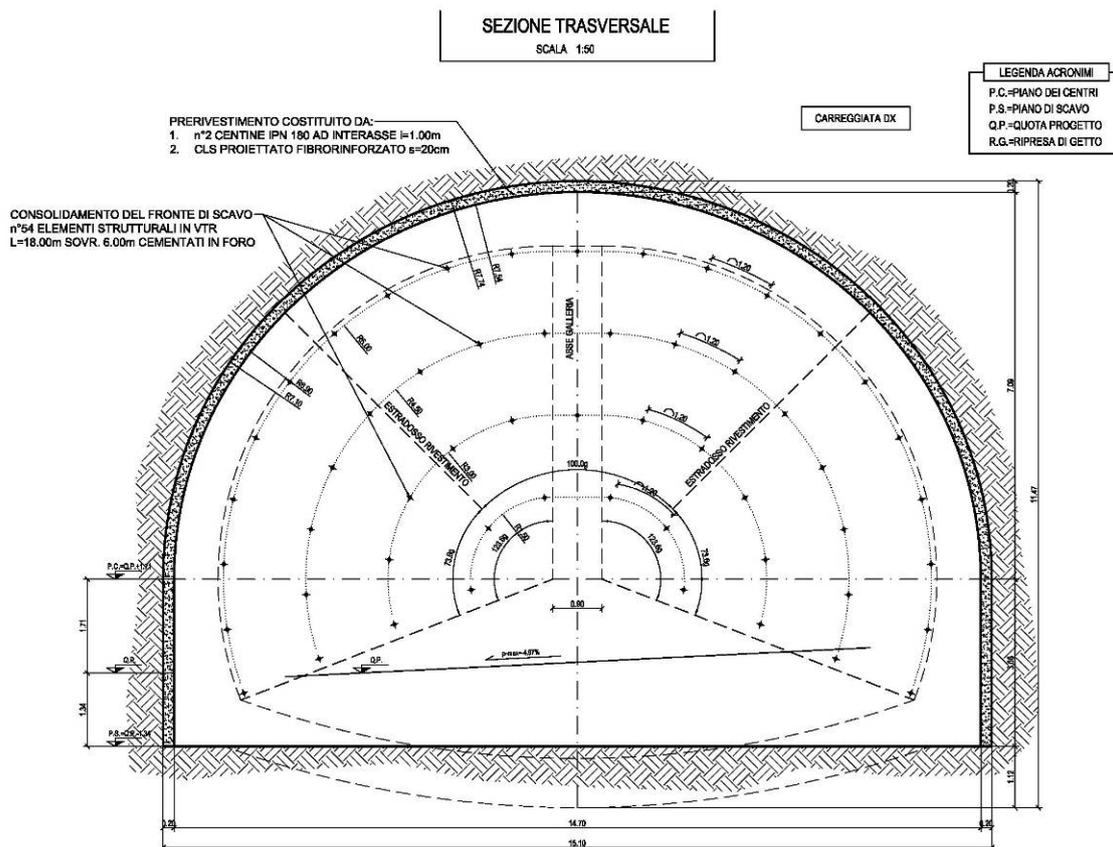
Sezione trasversale della sezione tipo B2 - Allargata.
